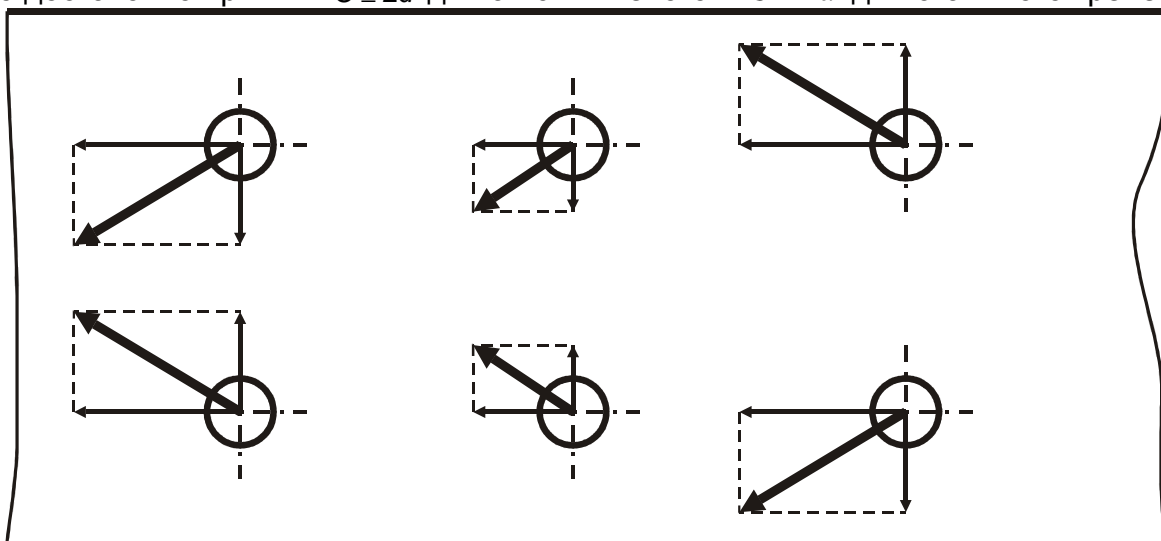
Схема нагружения крепежных элементов с учетом поперечных усилий
